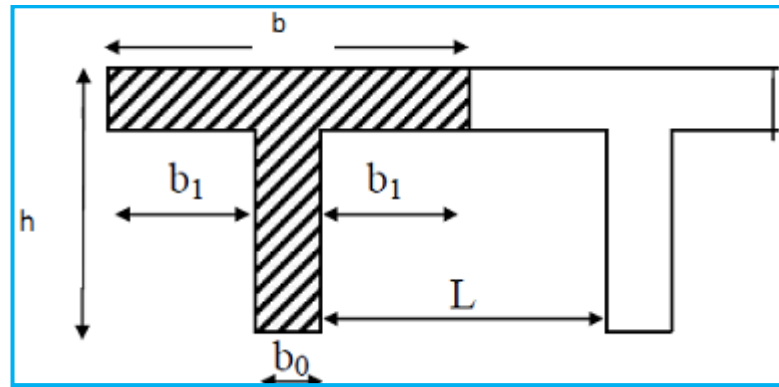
Section de la poutrelle après coulage de la dalle de compression
